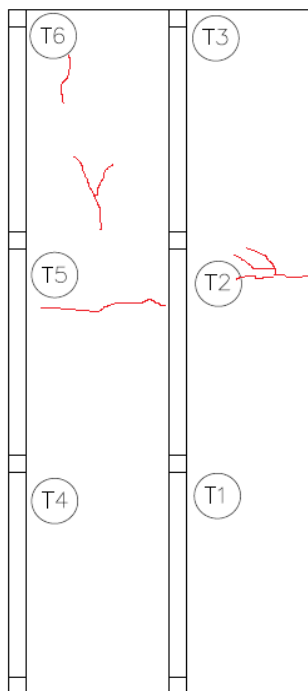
Ubicación de fisuras en tablero del margen izquierdo
